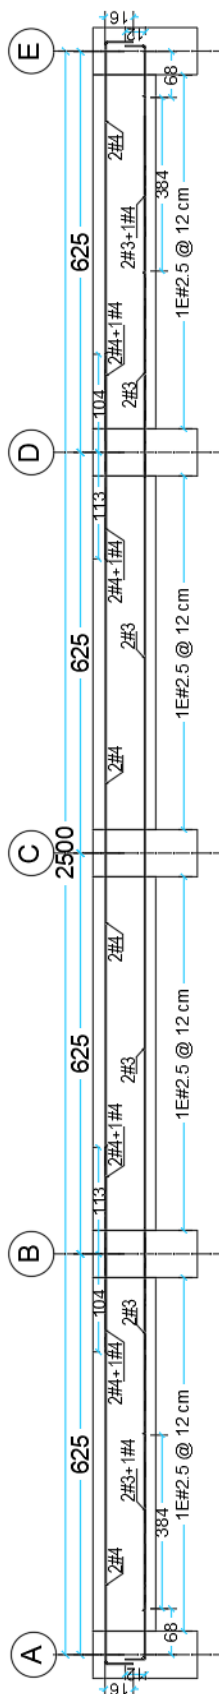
Armado de nervadura 1. (Elaboración propia)
